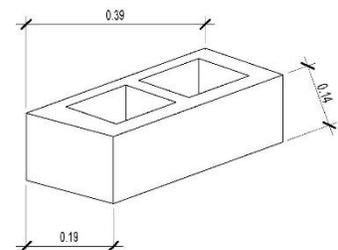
Premisa Sistema Constructivo. Fuente: Elaboración propia.
